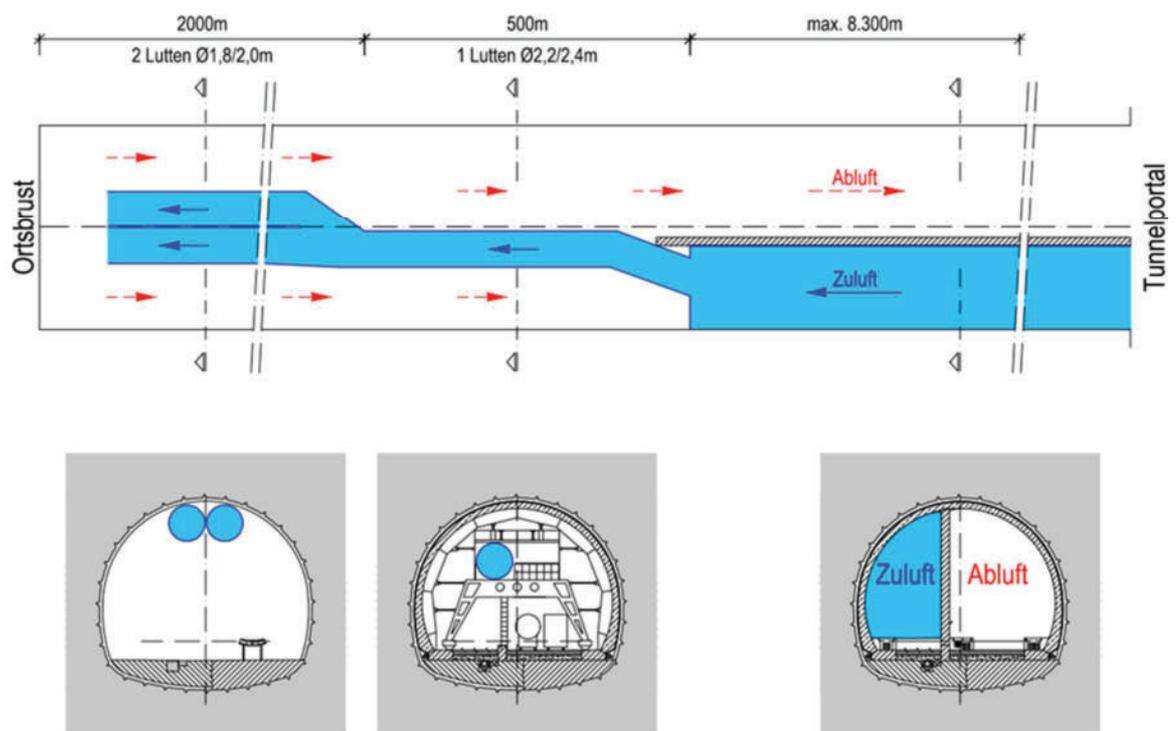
Lageplan und Querschnitte Lüftungsschema Vortrieb Tunnelquerschnitt mit Trennwand.
